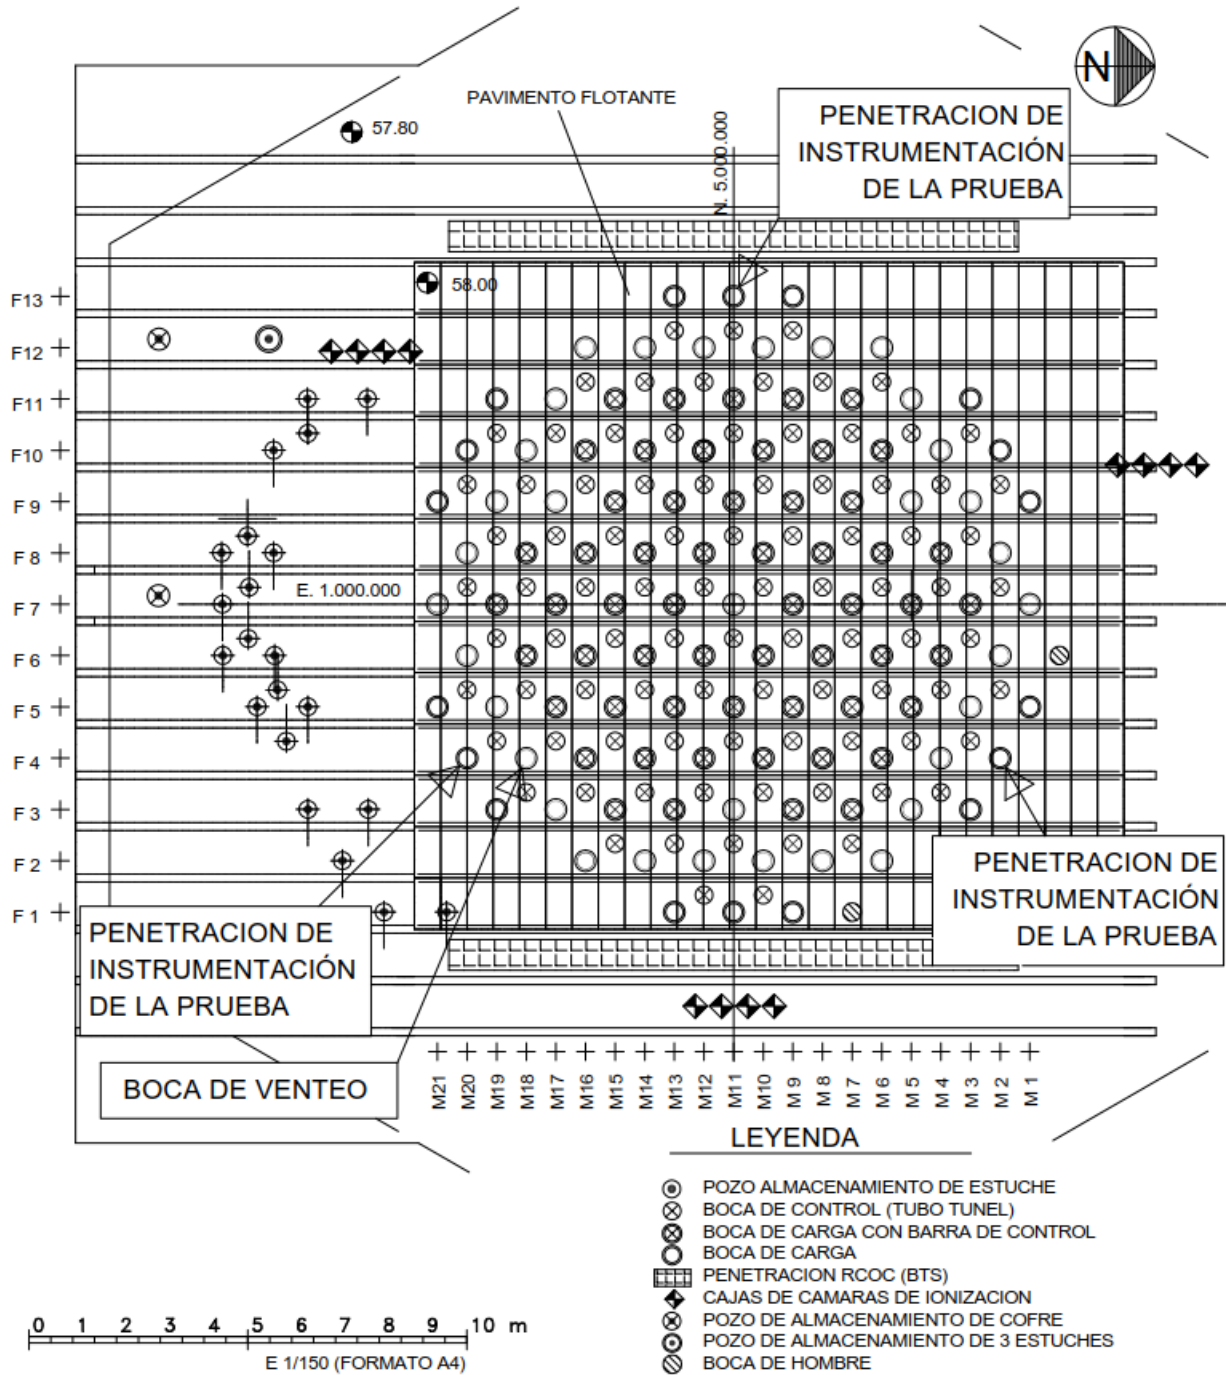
PLANTA DE PENETRACIONES EN LA LOSA DE OPERACIÓN
